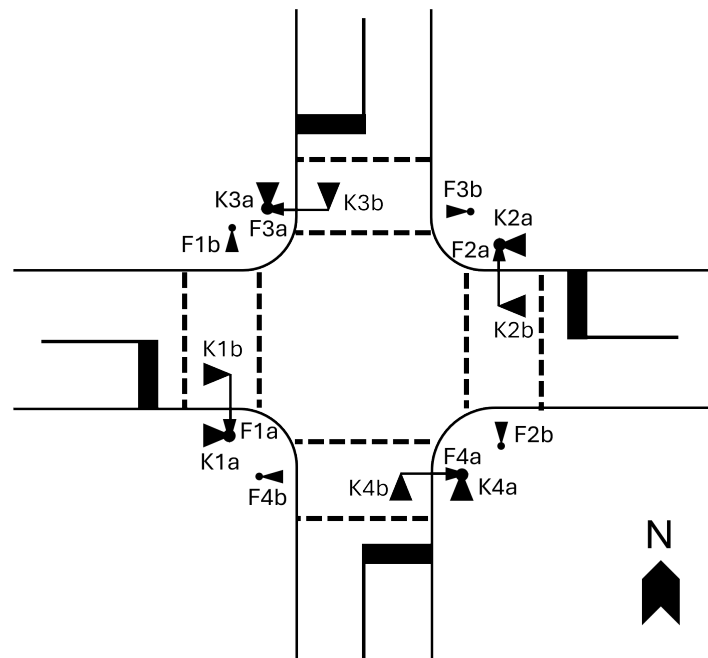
Lageplan für das Anwendungsbeispiel: Prüfung des möglichen Einsatzes einer GLOSA-Anwendung an einem symmetrischen Knotenpunkt.
